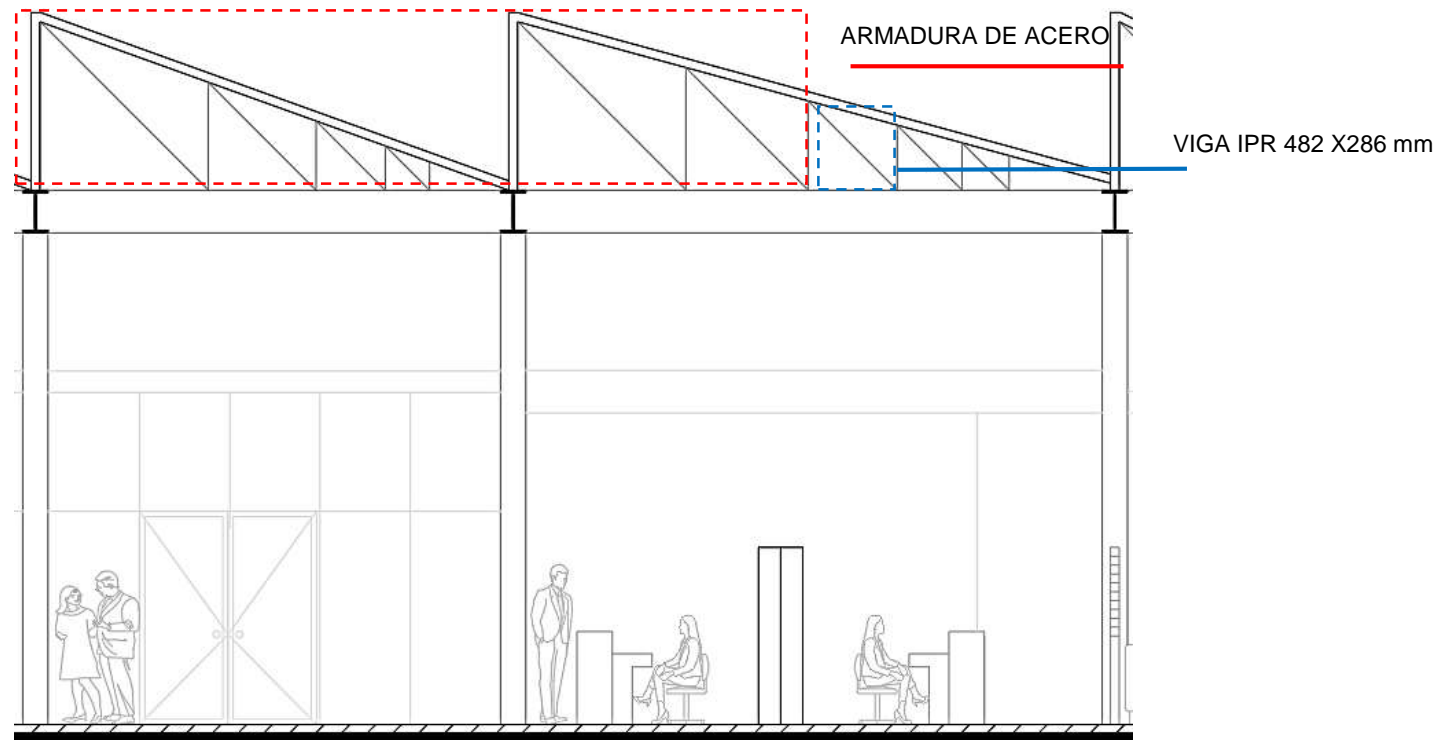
Estructura y armadura de acero con forma de diente de sierra visto en sección del proyecto. Elaboración propia.
